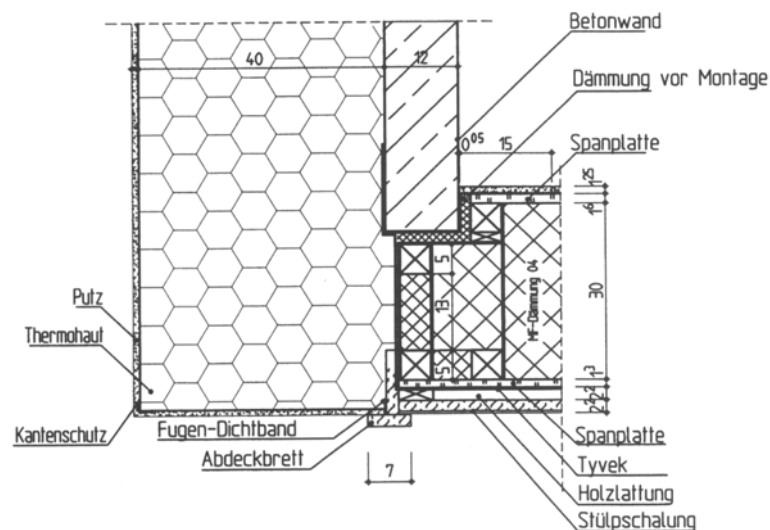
Anschluß der Fassadenelemente an die Giebelwand
